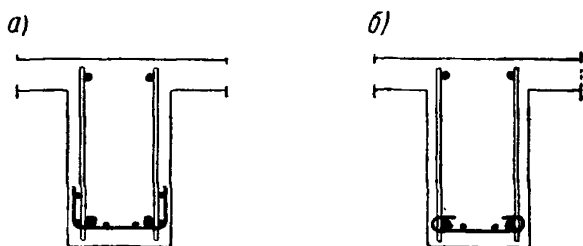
Дополнительное армирование балок в зоне отрицательных моментов сварными сетками, охватывающими сжатые стержни основных каркасов балок
